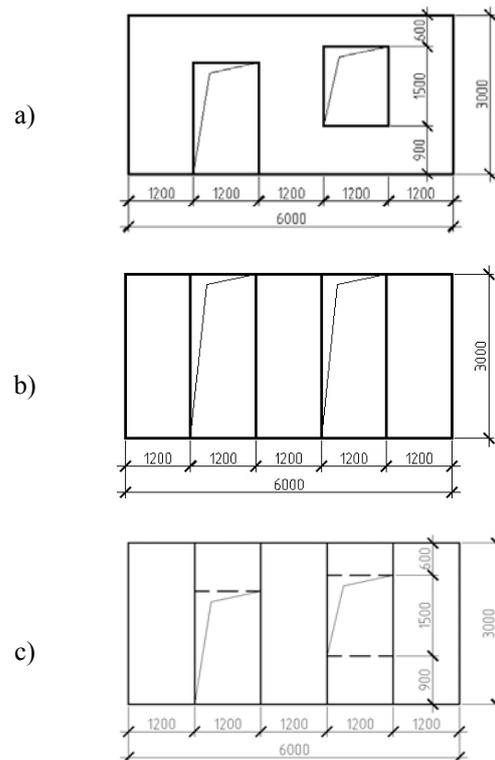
Méthodes de modélisation des ouvertures de parement de la construction du diaphragme / Methods of accounting openings in modeling work of shearwalls
